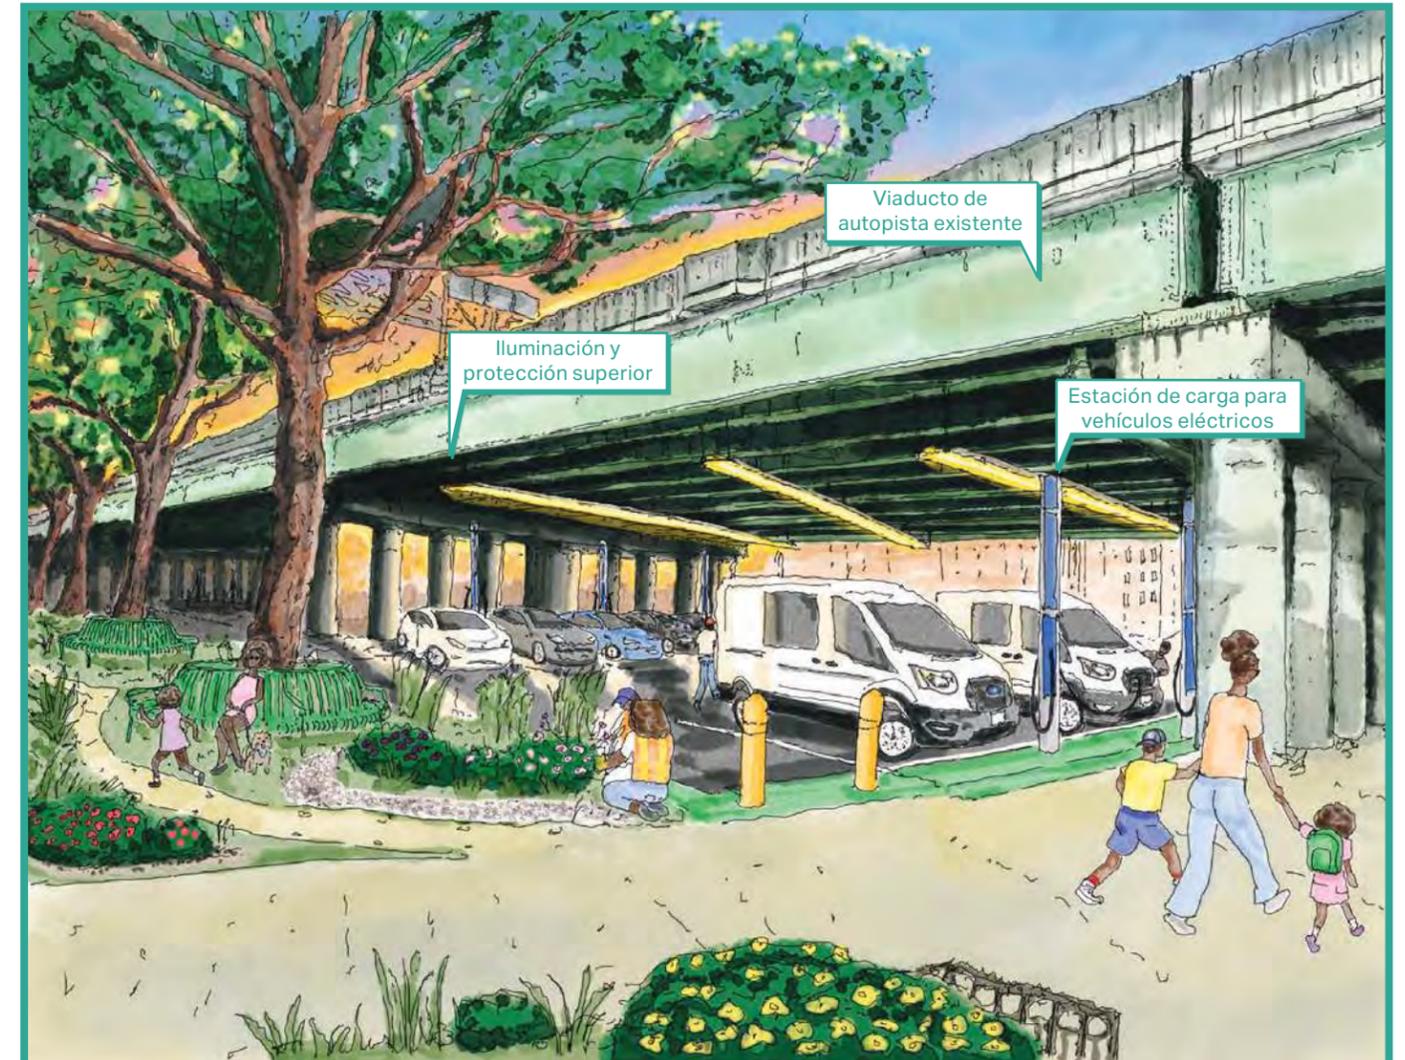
Ilustración de la activación bajo la estructura elevada entre Webster Avenue y 3rd Avenue
